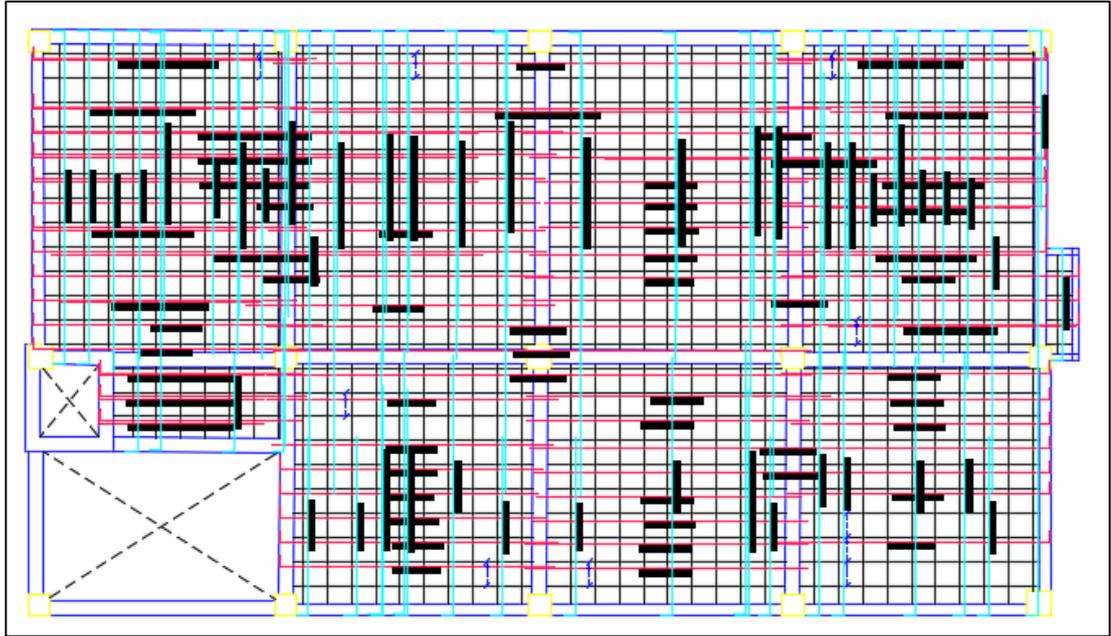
Esquema de armado de losa tipo N+1,62 (Hormigón)
